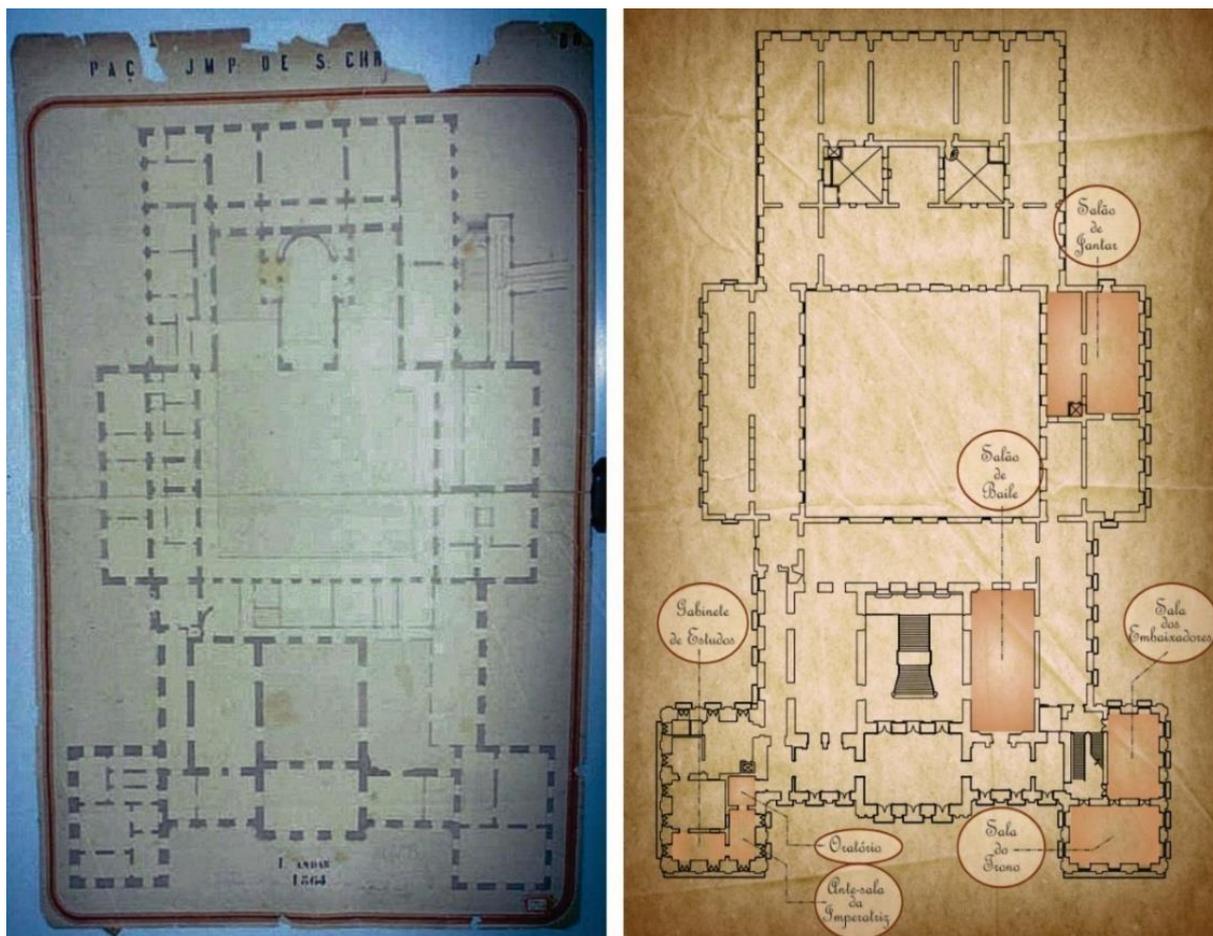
Planta baixa do 2º Pavimento Paço; à esquerda em 1864 e à direita atualmente.
